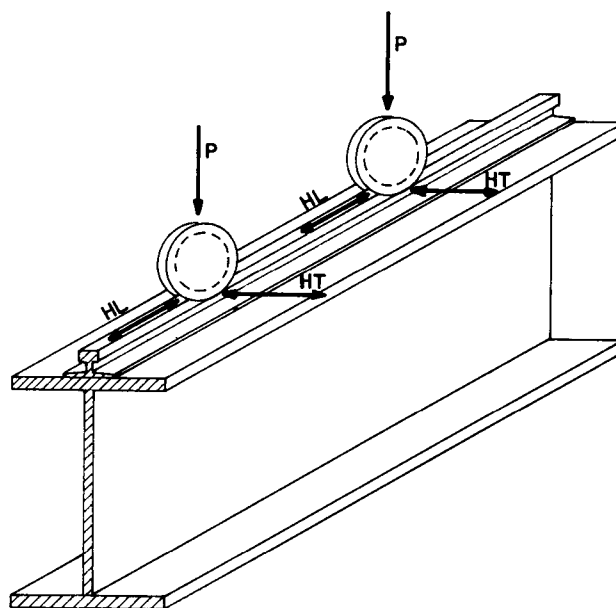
Esforços em vigas de rolamento causados pelas pontes rolantes
